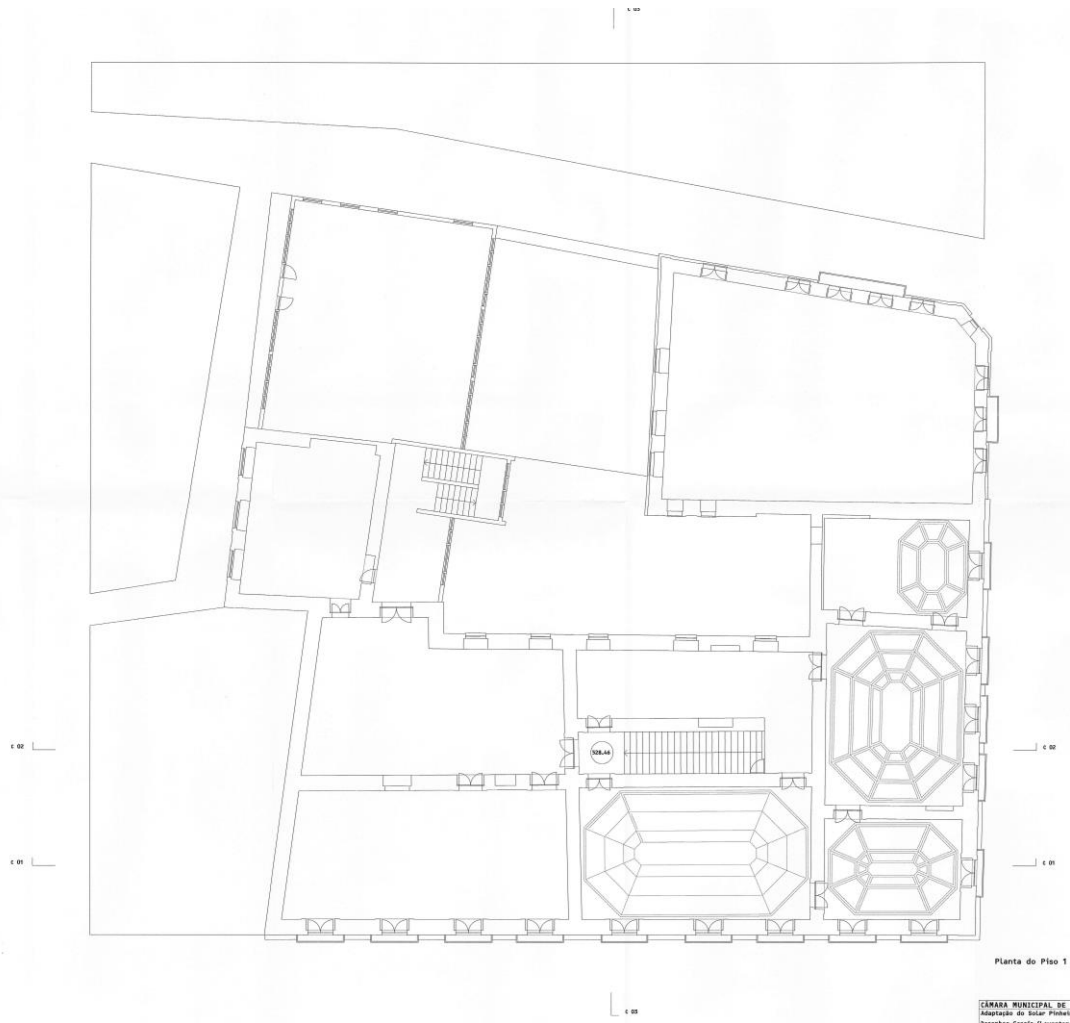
Planta do Piso 1. Escala 1/100. Projeto abril 2007. L.3. Câmara Municipal de Lamego. Adaptação do Solar Pinheiro de Aragão a Biblioteca Municipal. Execução. Desenhos Gerais, (Levantamento)<sup>98</sup>.
